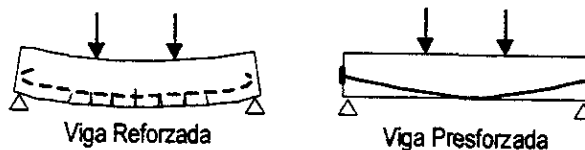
Deformación y agrietamiento en vigas de concreto reforzado y presforzado.
